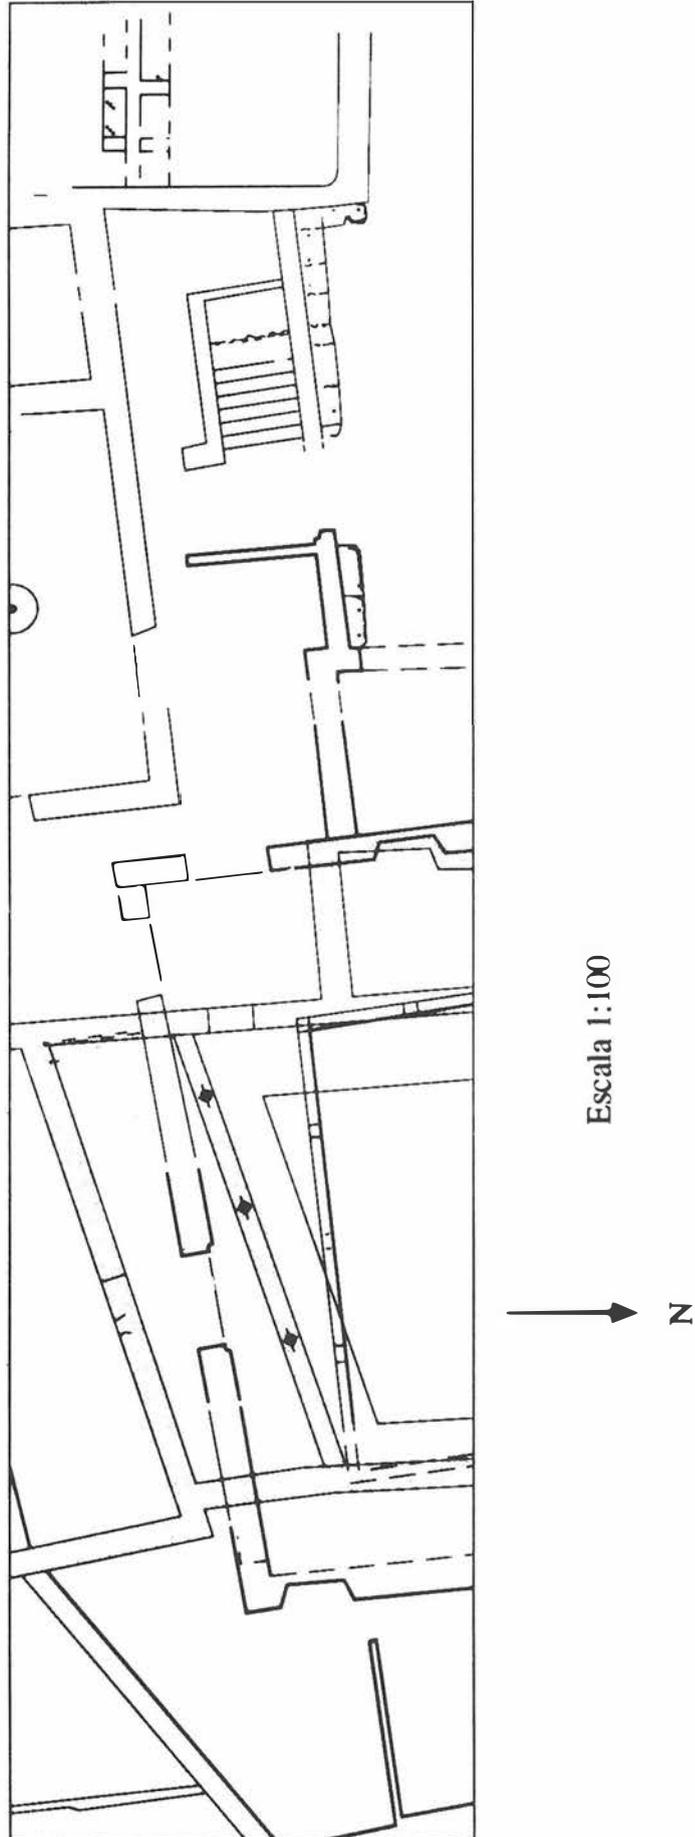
Planta de la Casa de los Condes de Mayorga y luna sobre la planta general del Convento de la Encarnación.
